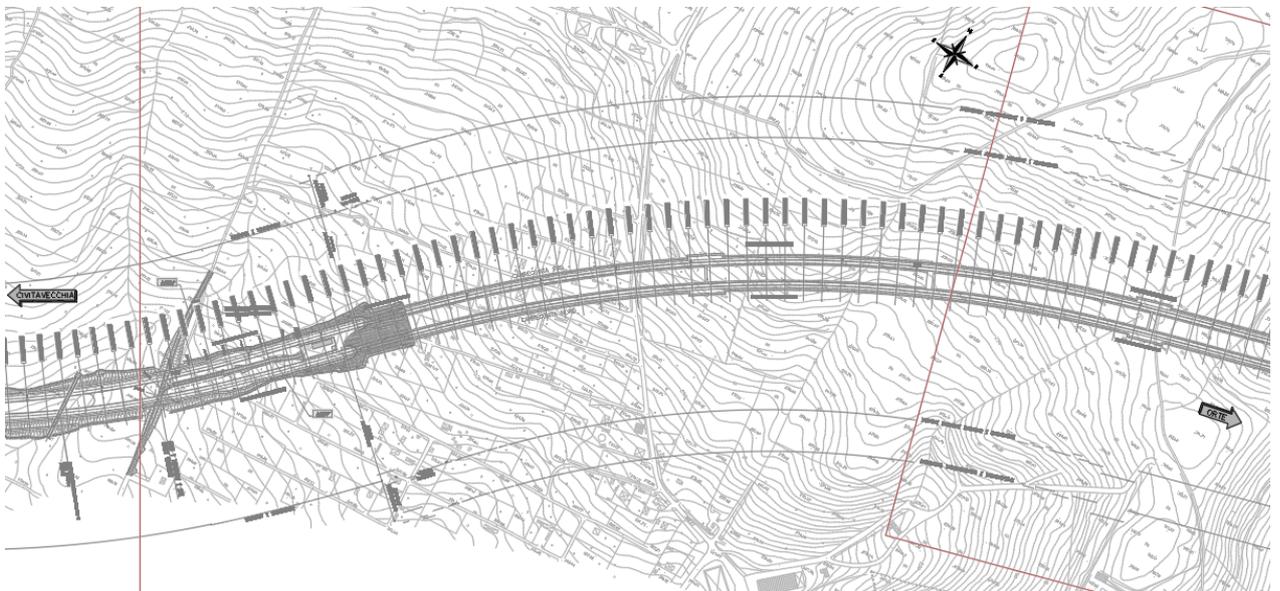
Stralcio planimetria fine galleria Monteromano (L=1566,30m)
